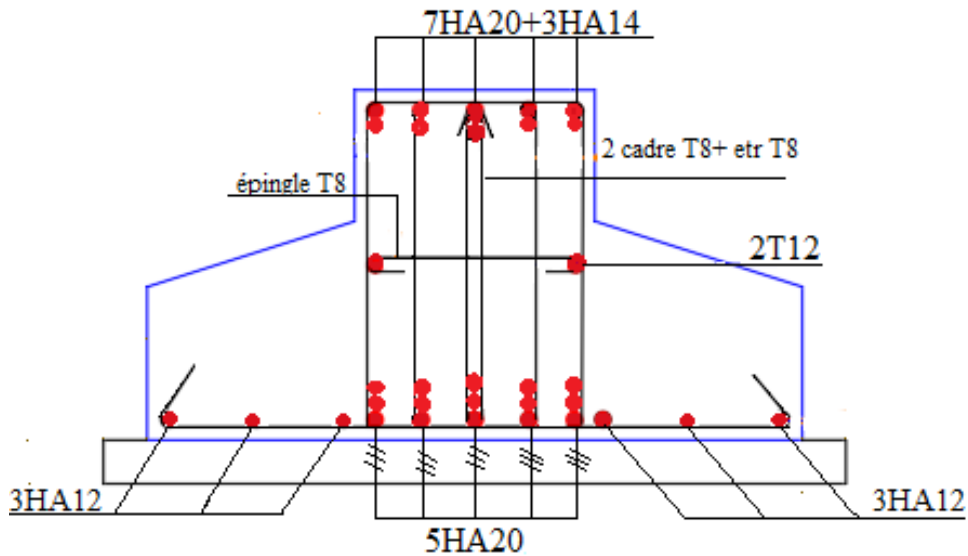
Schéma de ferrailage d'une Semelle filante
